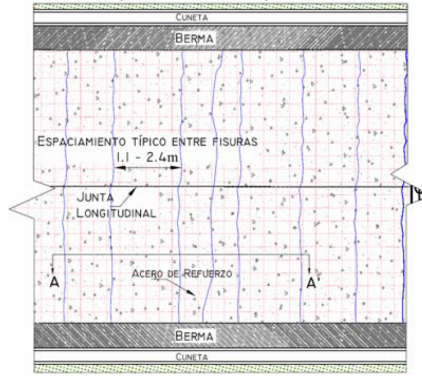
Vista en planta de una losa con refuerzo continuo (INVIAS, 2006)
